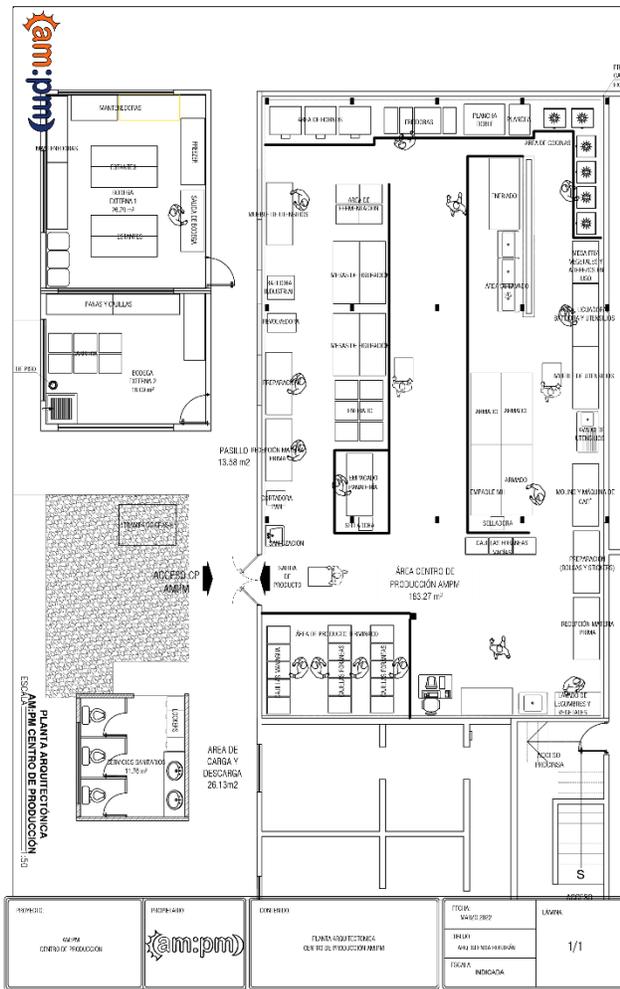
Planta Arquitectónica definitiva Centro de Producción AMPM en Complejo Industrial San Antonio
